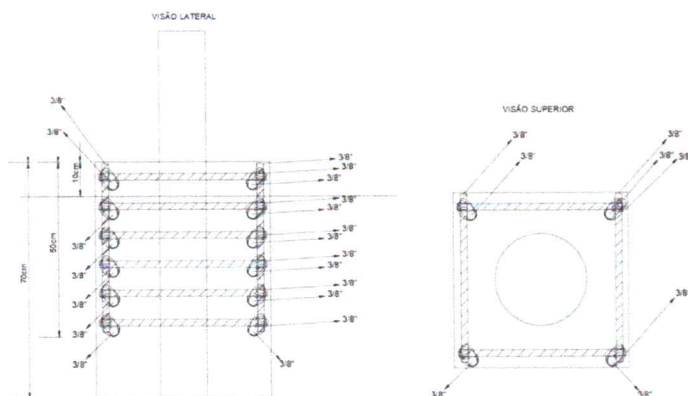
BASE DE CONCRETO ARMADO REFORÇADA – POSTES DE 5 E 6 METROS
